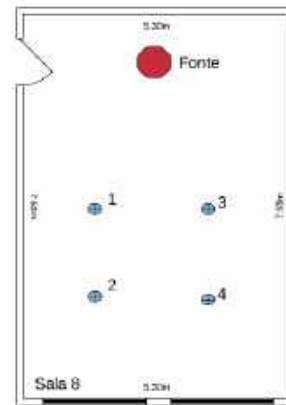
Planta baixa, com indicação do posicionamento da fonte e receptores, da Sala 8. (Os autores, 2018).
